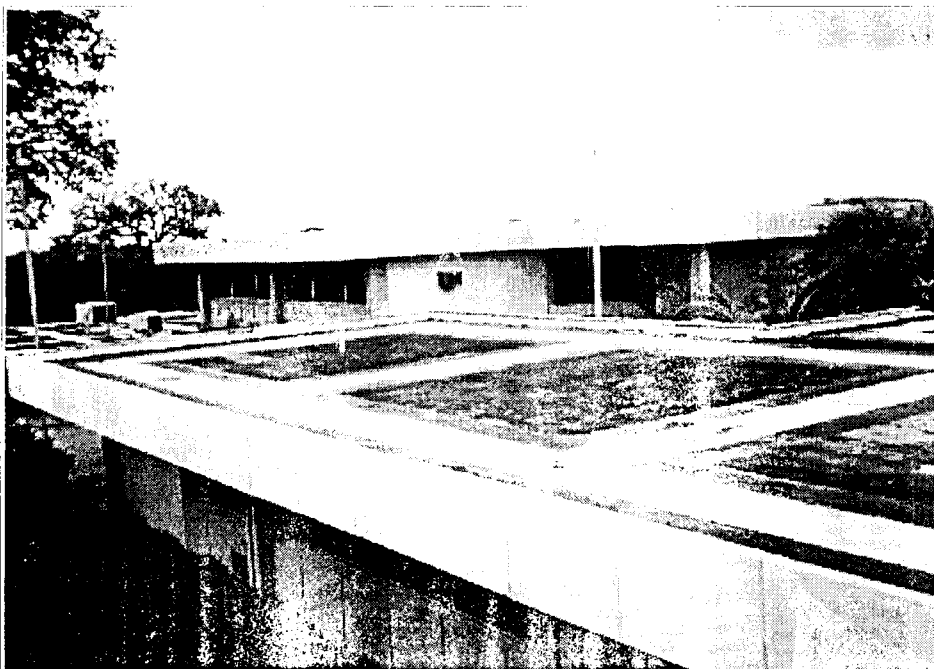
Laboratorios F.I.C.T.*: Petróleo: enlucido paredes y tumbado. En mal estado este último por filtración en losa de cubierta.
